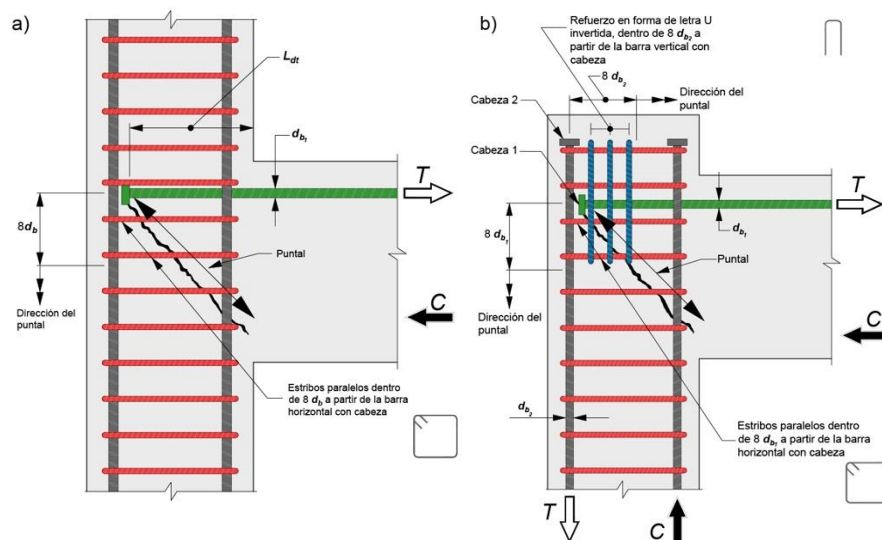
Refuerzo transversal paralelo a barras corrugadas con cabeza dentro de una unión viga columna: a) barras corrugadas con cabeza horizontales y b) barras corrugadas con cabeza horizontales y verticales
